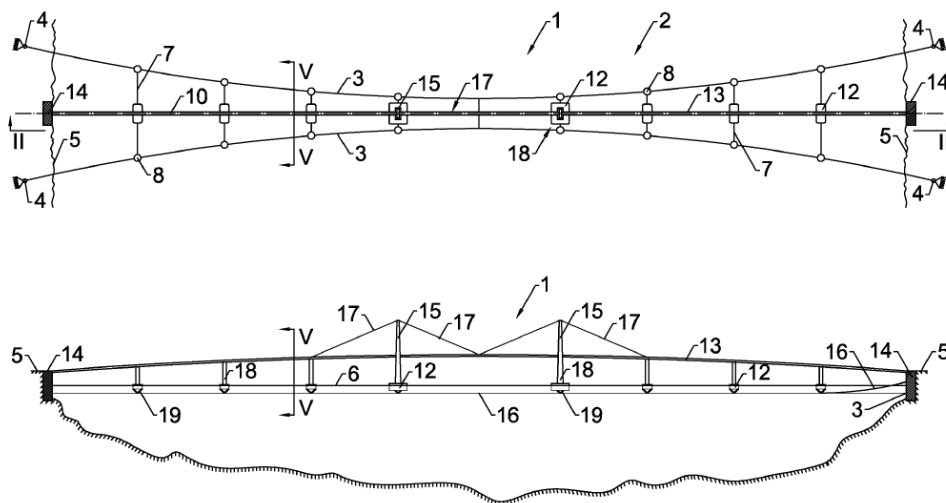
Grundriss und Längsschnitt II, Variante 1a (Kollegger, et al., 2015)
